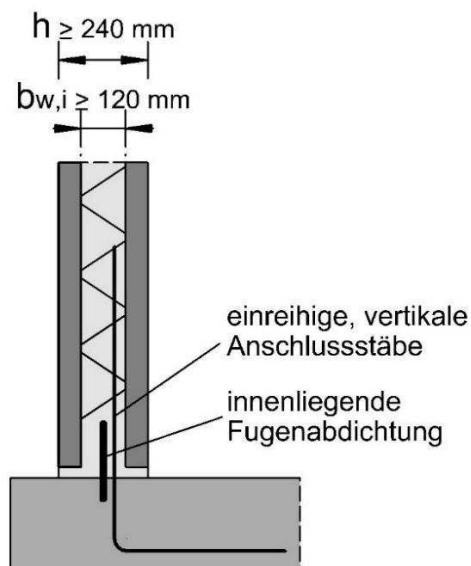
Elementwand mit Wanddicke von 240 mm und innenliegender Fugenabdichtung und einreihiger Anschlussbewehrung aus einzelnen vertikalen Bewehrungsstäben
